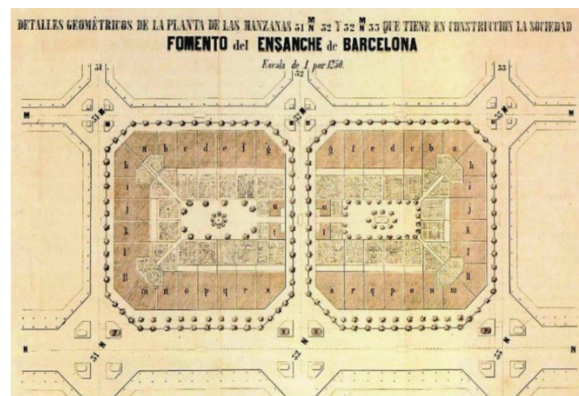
Planta geral do Plano Cerdà para Barcelona
